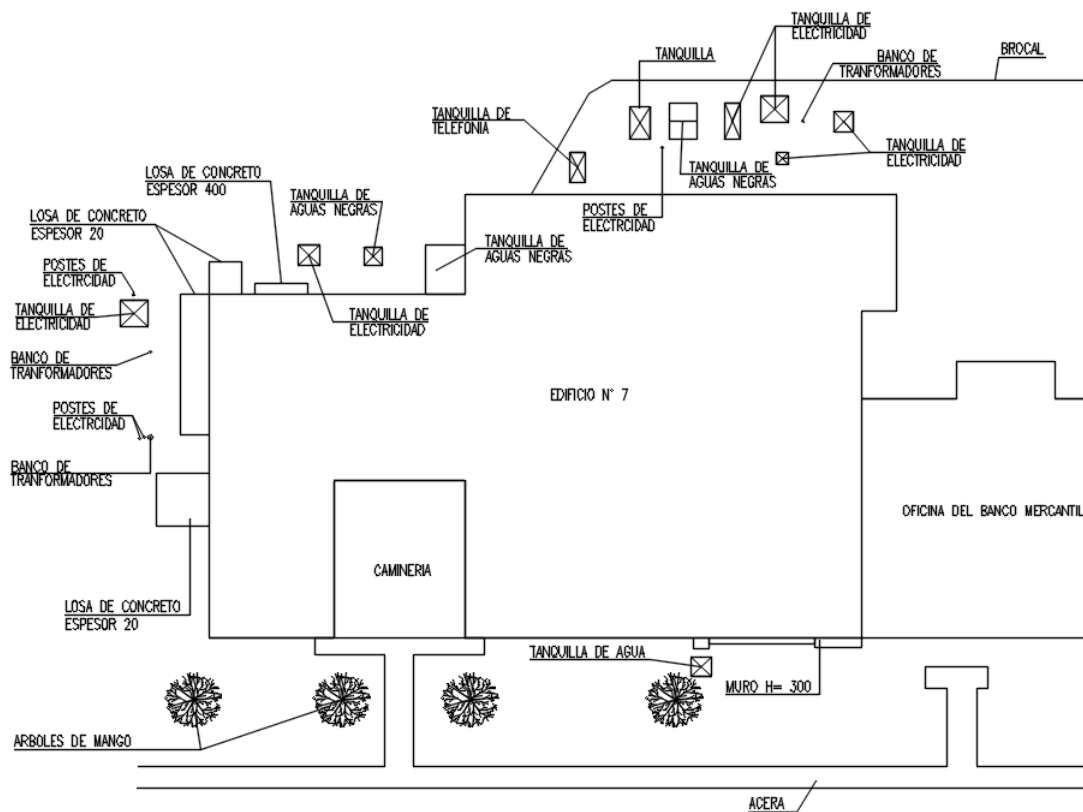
Levantamiento de las facilidades externas del ala izquierda del EN7 y obstrucciones laterales. Fuente: Autor.
